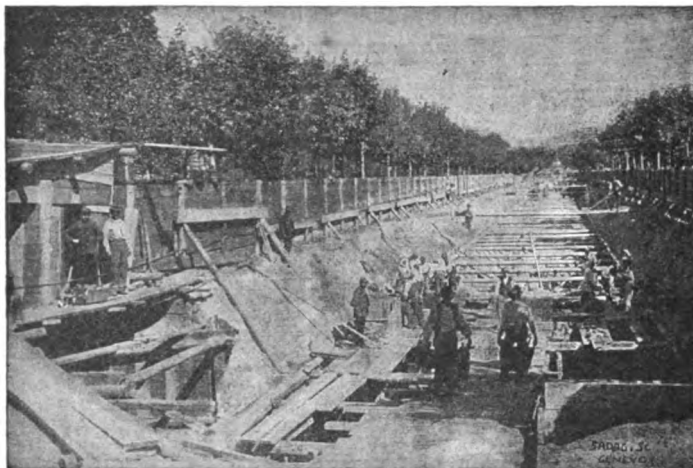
Construction du tunnel au-dessous de la rue Andrassy.
